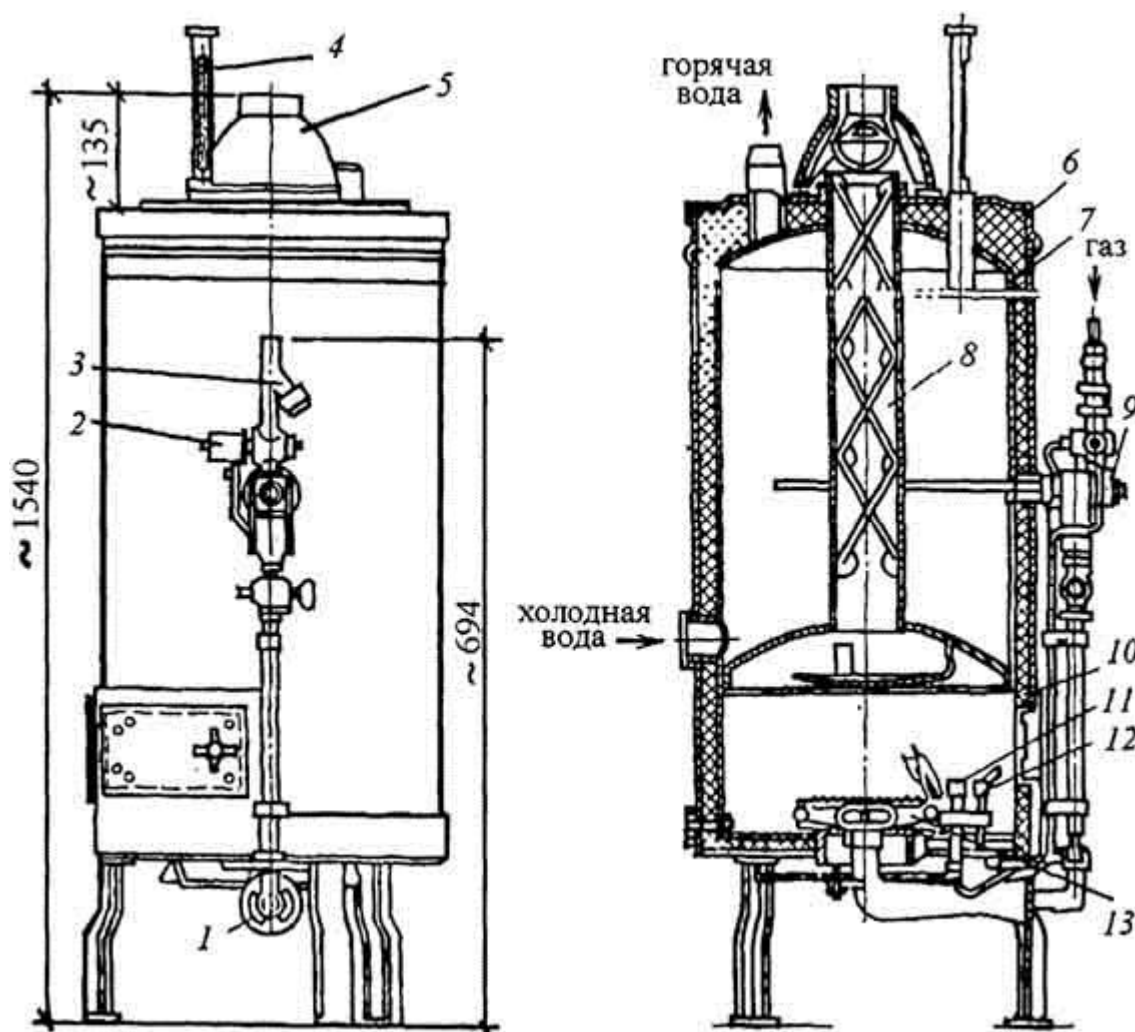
Газовый емкостной водонагреватель типа АГВ: 1 - регулятор первичного воздуха основной горелки; 2 - электромагнитный клапан; 3 - газовый фильтр; 4 - блок автоматики безопасности; 5 - тягопрерыватель; 6 - кожух; 7 - резервуар; 8 - жаровая труба; 9 - терморегулятор; 10 - тепловая изоляция; 11 - запальная горелка; 12 - термопара; 13 - основная горелка
